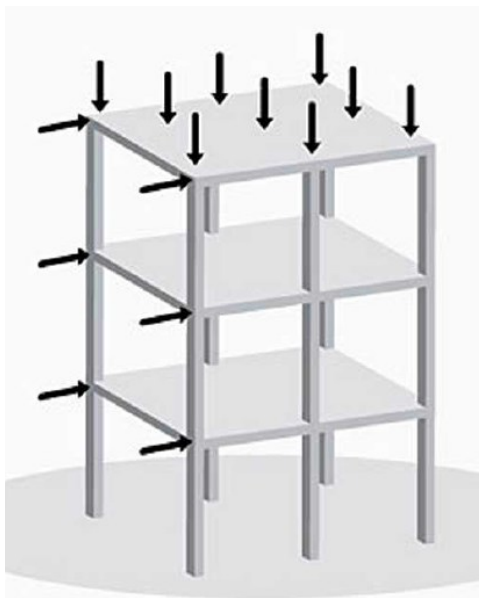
Pórtico espacial com lajes (KIMURA, 2007)
